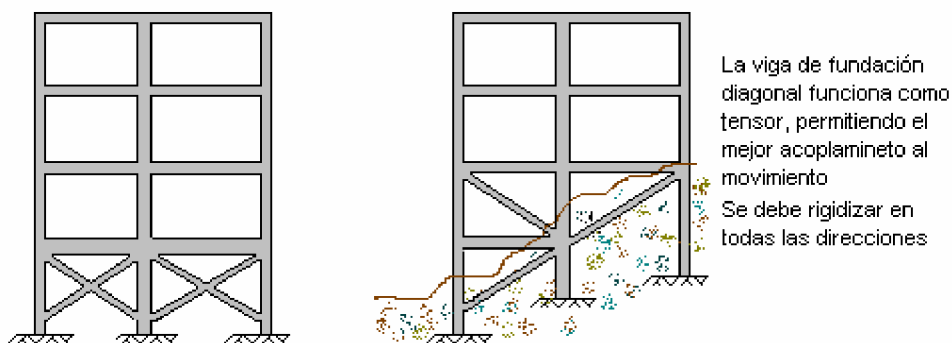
Vigas para arriostramiento en edificios construidos en laderas.
